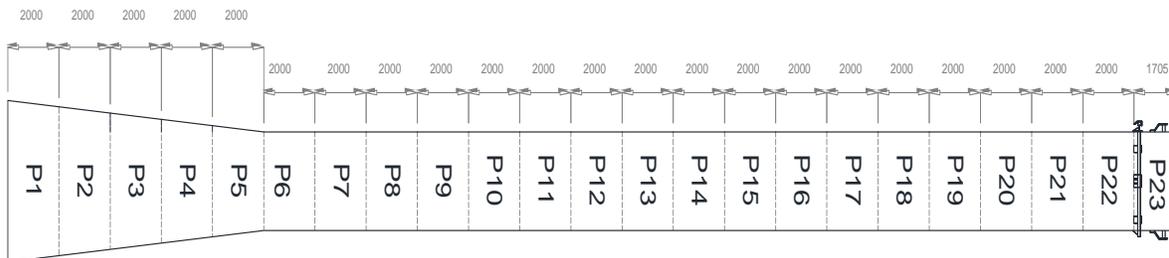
Distribución de anillos en chimeneas de los calentadores. Fuente: Planos del proyecto.
